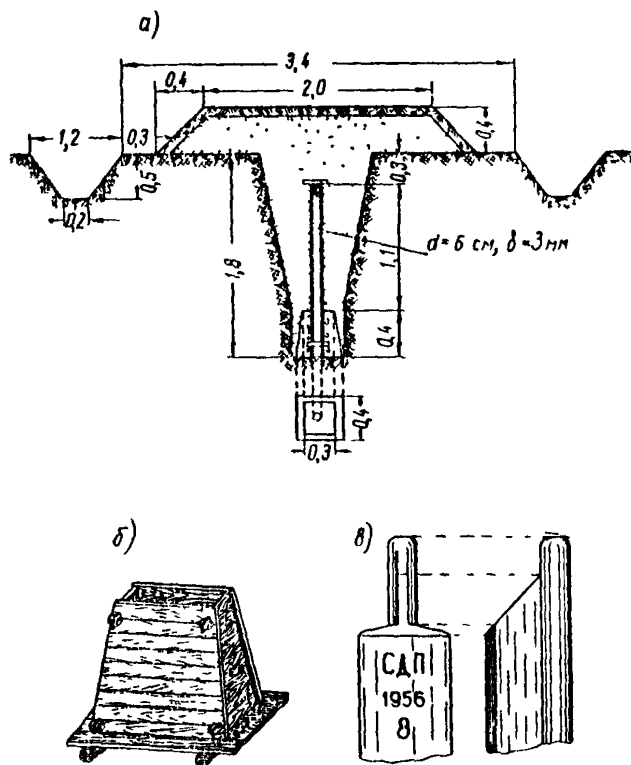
Грунтовые реперы: а — трубчатый грунтовый репер, б — деревянная форма для изготовления бетонного монолита, в — рельсовый грунтовый репер
